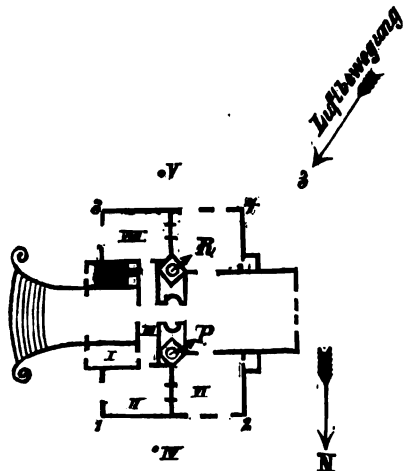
Grundriss der Villa in Zehlendorf.
